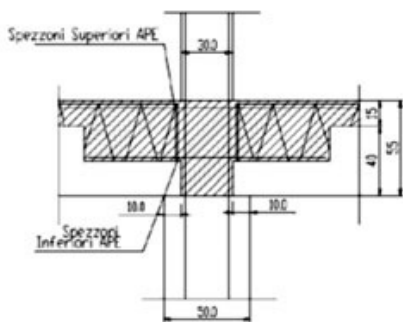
Schema del collegamento tra pilastri inferiori e superiori nella mezzeria dell'edificio.
